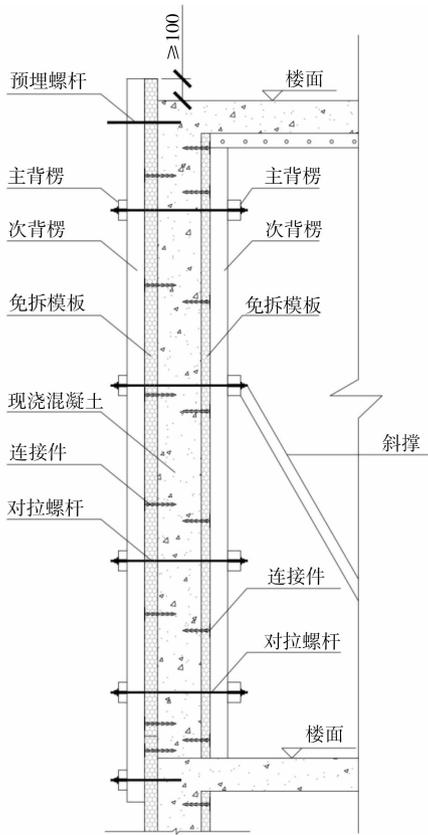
免拆模板内外叠加体系组合构造示意图
